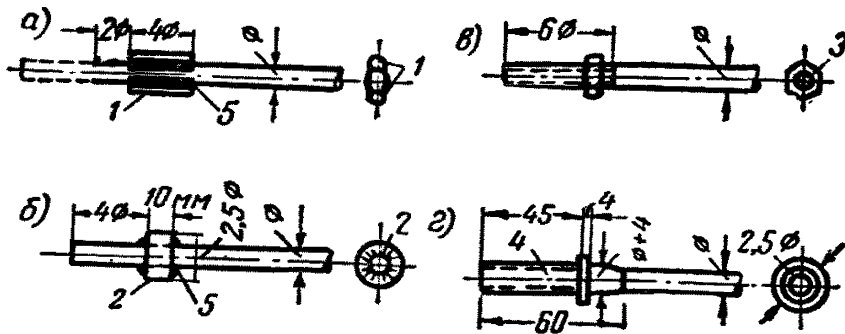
Анкеровка арматуры круглого профиля из мягких сталей в предварительно напряженных железобетонных конструкциях
